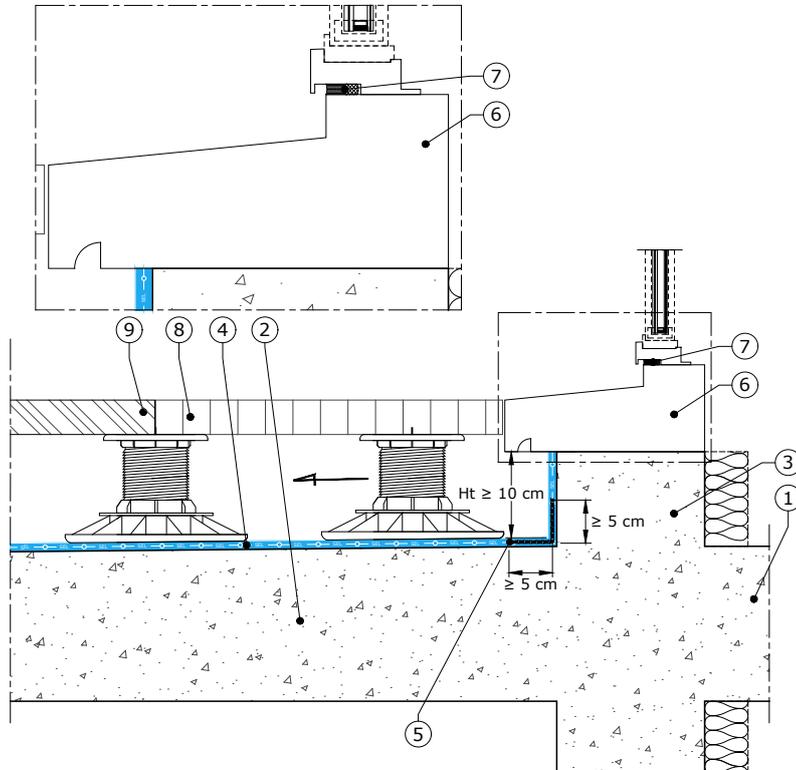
Exemple de seuil avec relevé de hauteur minimale de 10 cm - Cas particulier de la protection par dalles sur plots
